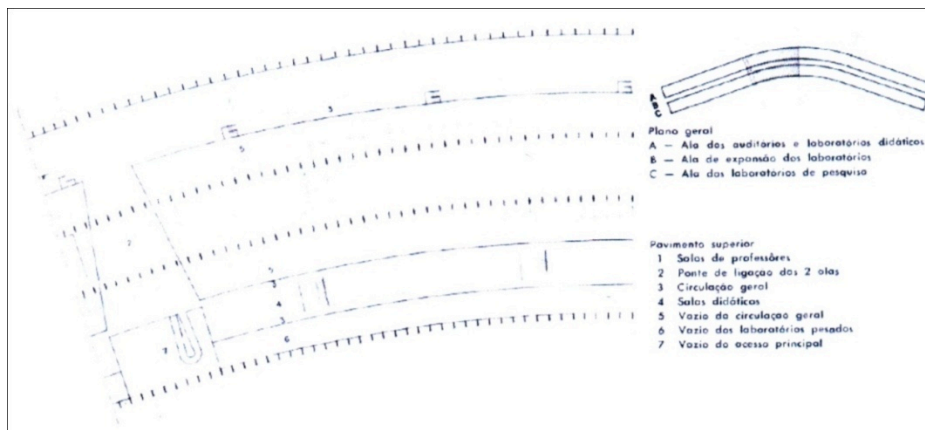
Planta Baixa pavimento superior ICC. Fonte: Acrópole, 1970.
